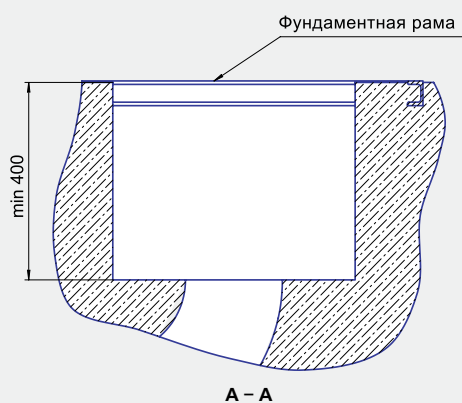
Пример конструкции фундаментной рамы и кабельного приемка
